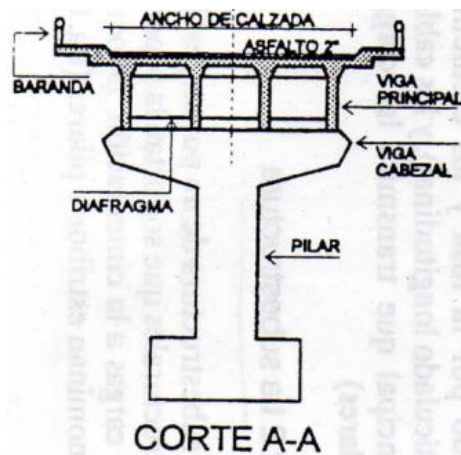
Puente Tipo Viga. Fuente: Puentes: Análisis, Diseño y Construcción (López), 1994.
